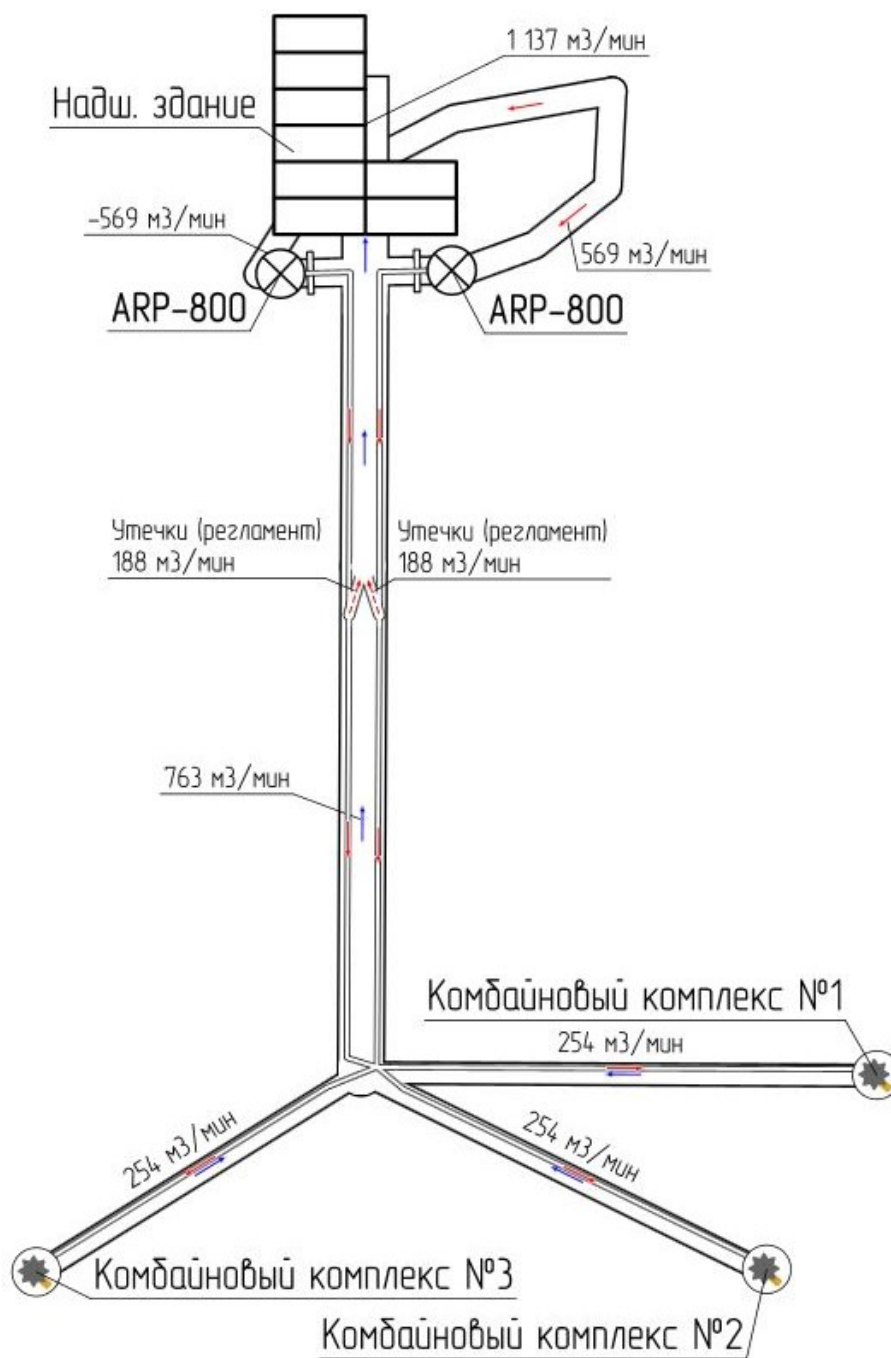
Схема проветривания трех рабочих зон комбайновых комплексов (при проходке межстволовой сбойки и выработок околоствольного двора) двумя параллельно установленными вентиляторными установками ARP-800 через вентиляционный трубопровод
